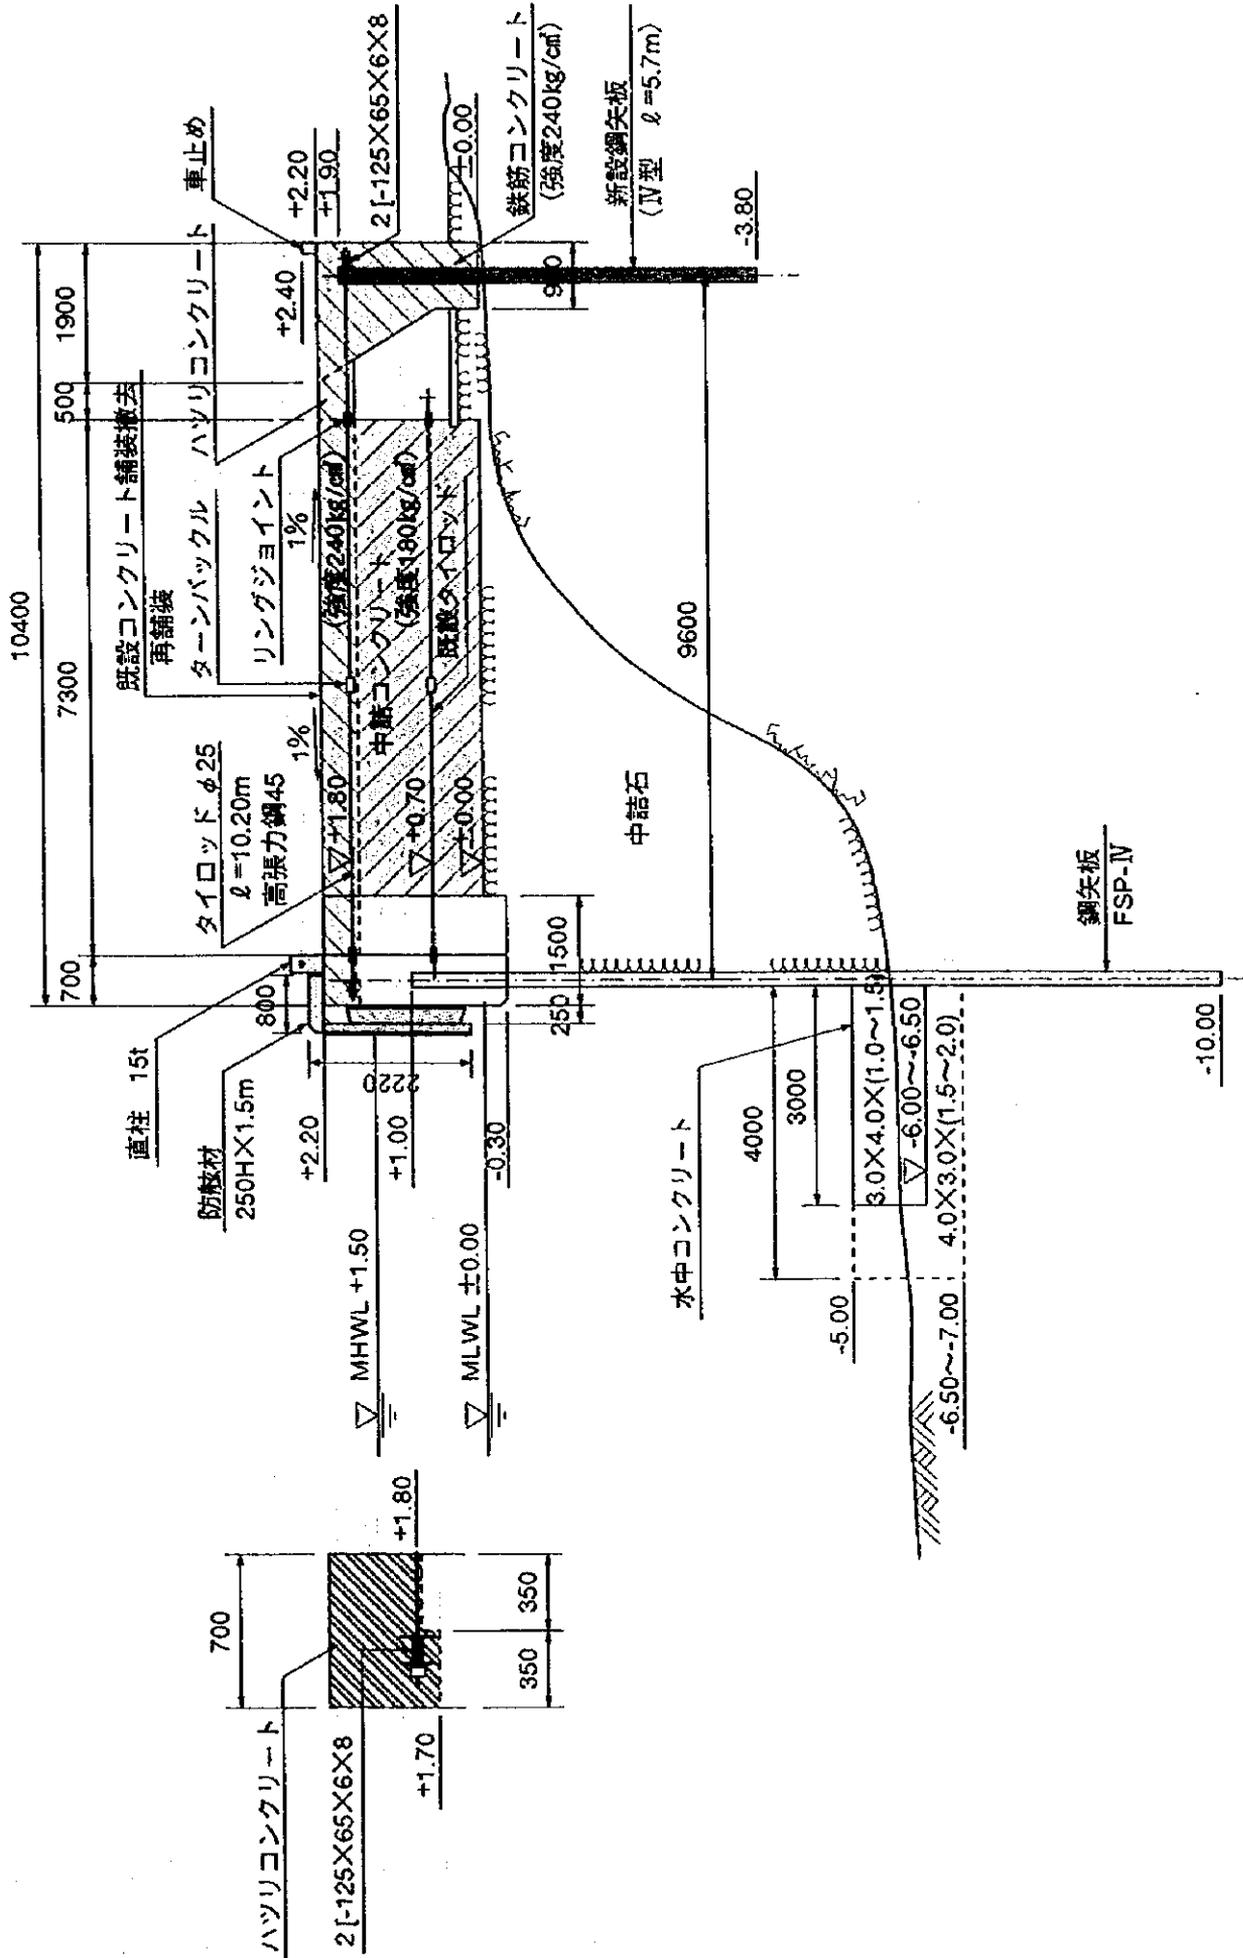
埠頭控え工復旧標準断面図 (①-①断面)
